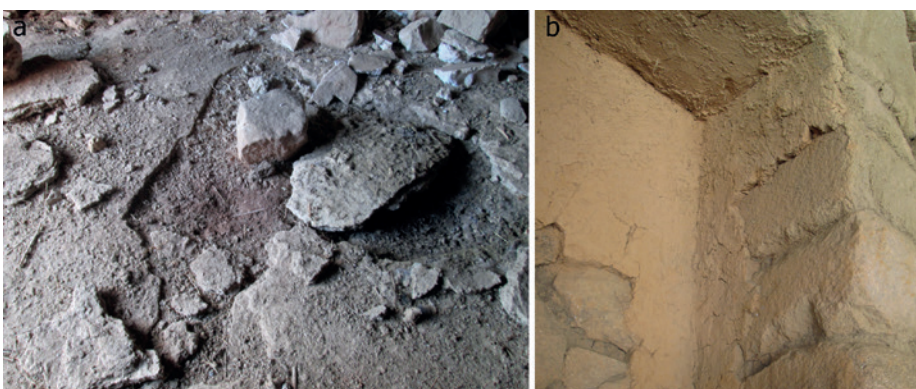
a. Pavimento de tierra apisonada en el interior de una estructura (Hortichuela, Valencia). b. Revestimiento de barro cubriendo un muro de bloques escuadrados de piedra (Machu Picchu, Perú).
